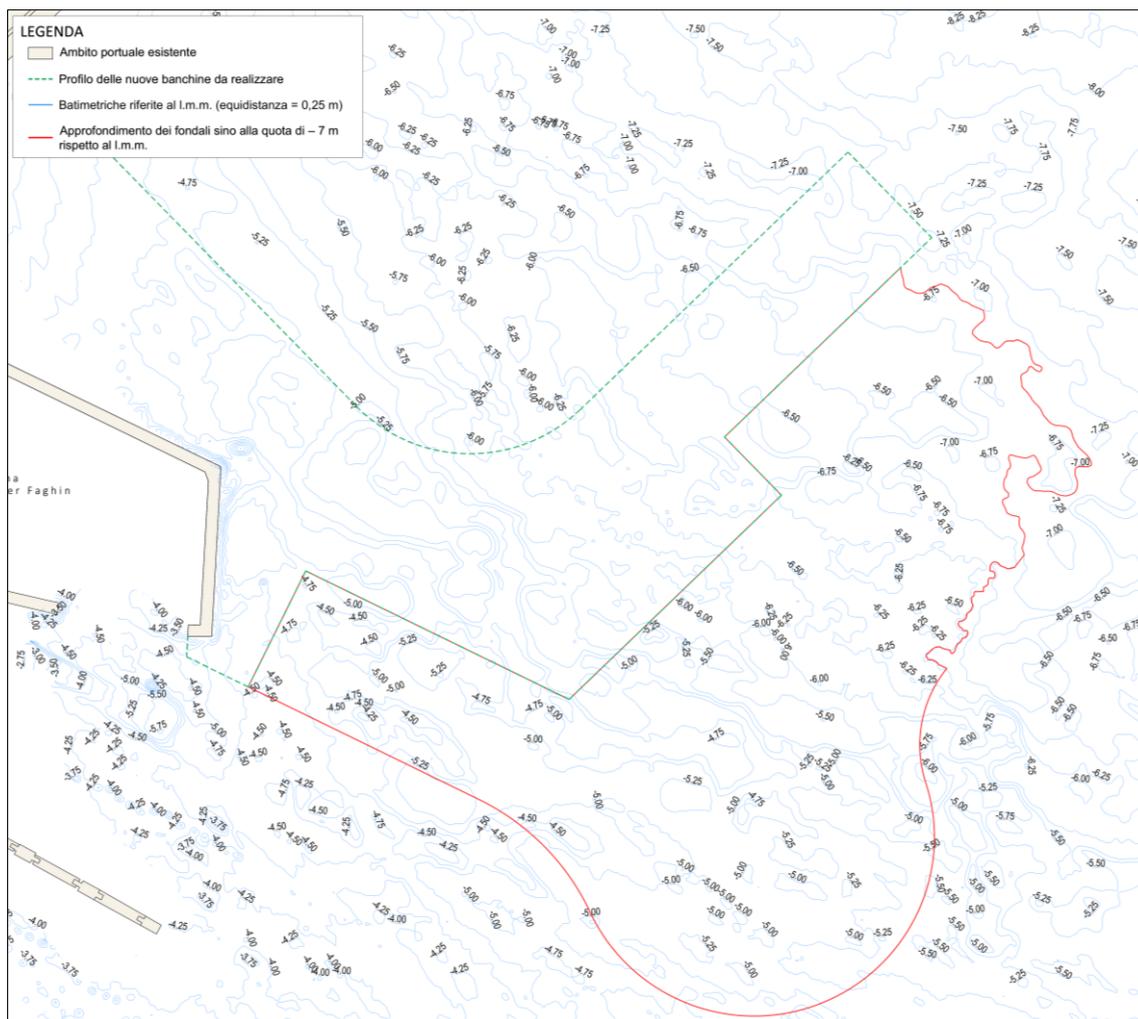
Planimetria con l'individuazione dell'area oggetto di approfondimento dei fondali
